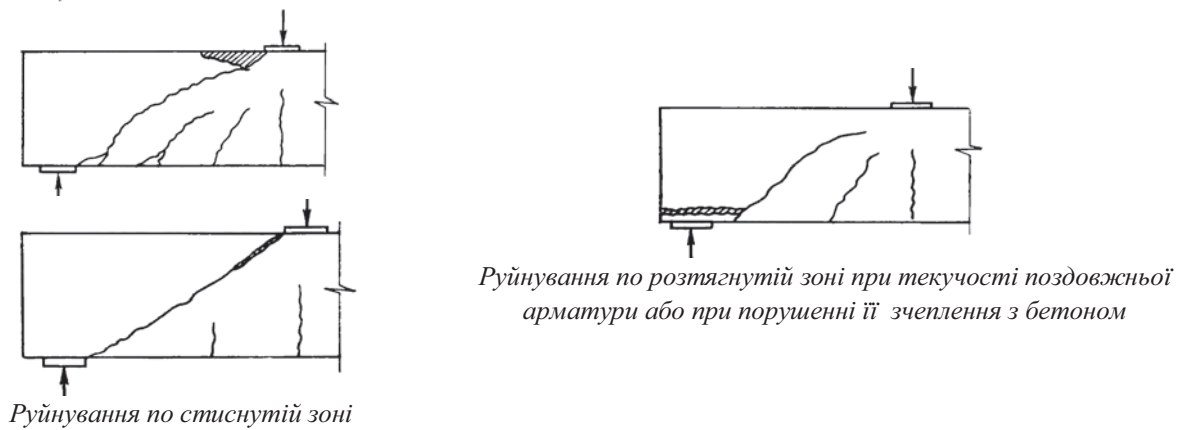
Схеми руйнування залізобетонних балок по похилих перерізах за [7]
